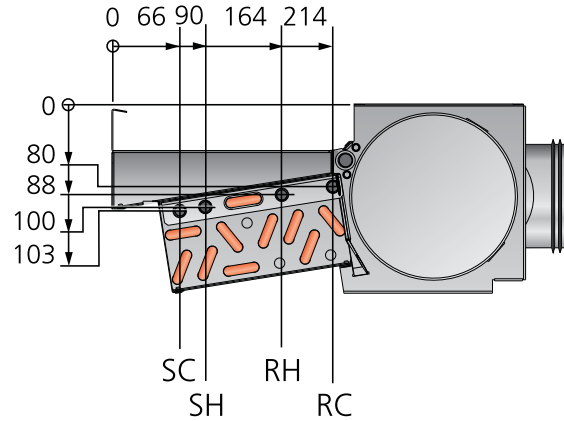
Rohranschlüsse für die Länge 800 mm
